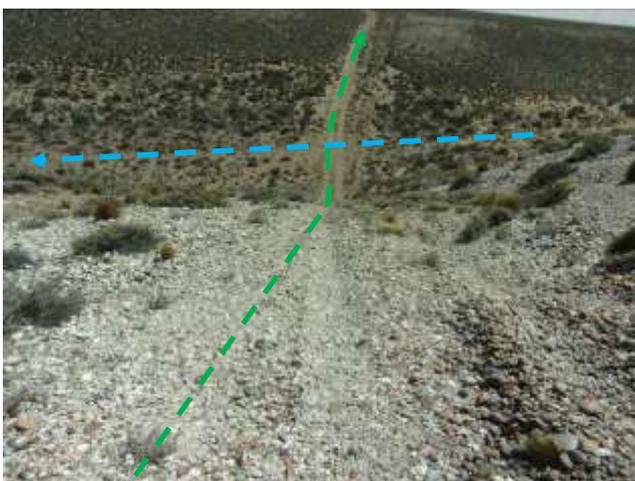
Emplazamiento de línea de inyección por margen interno de camino. Foto en dirección O.
